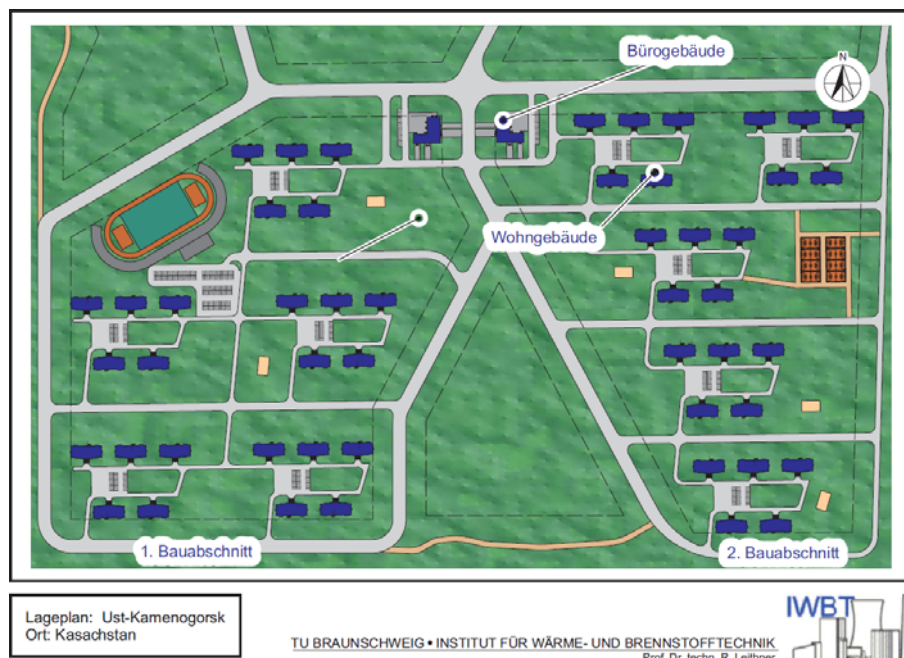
Lageplan der Siedlung „KSch“ in Ust-Kamenogorsk
